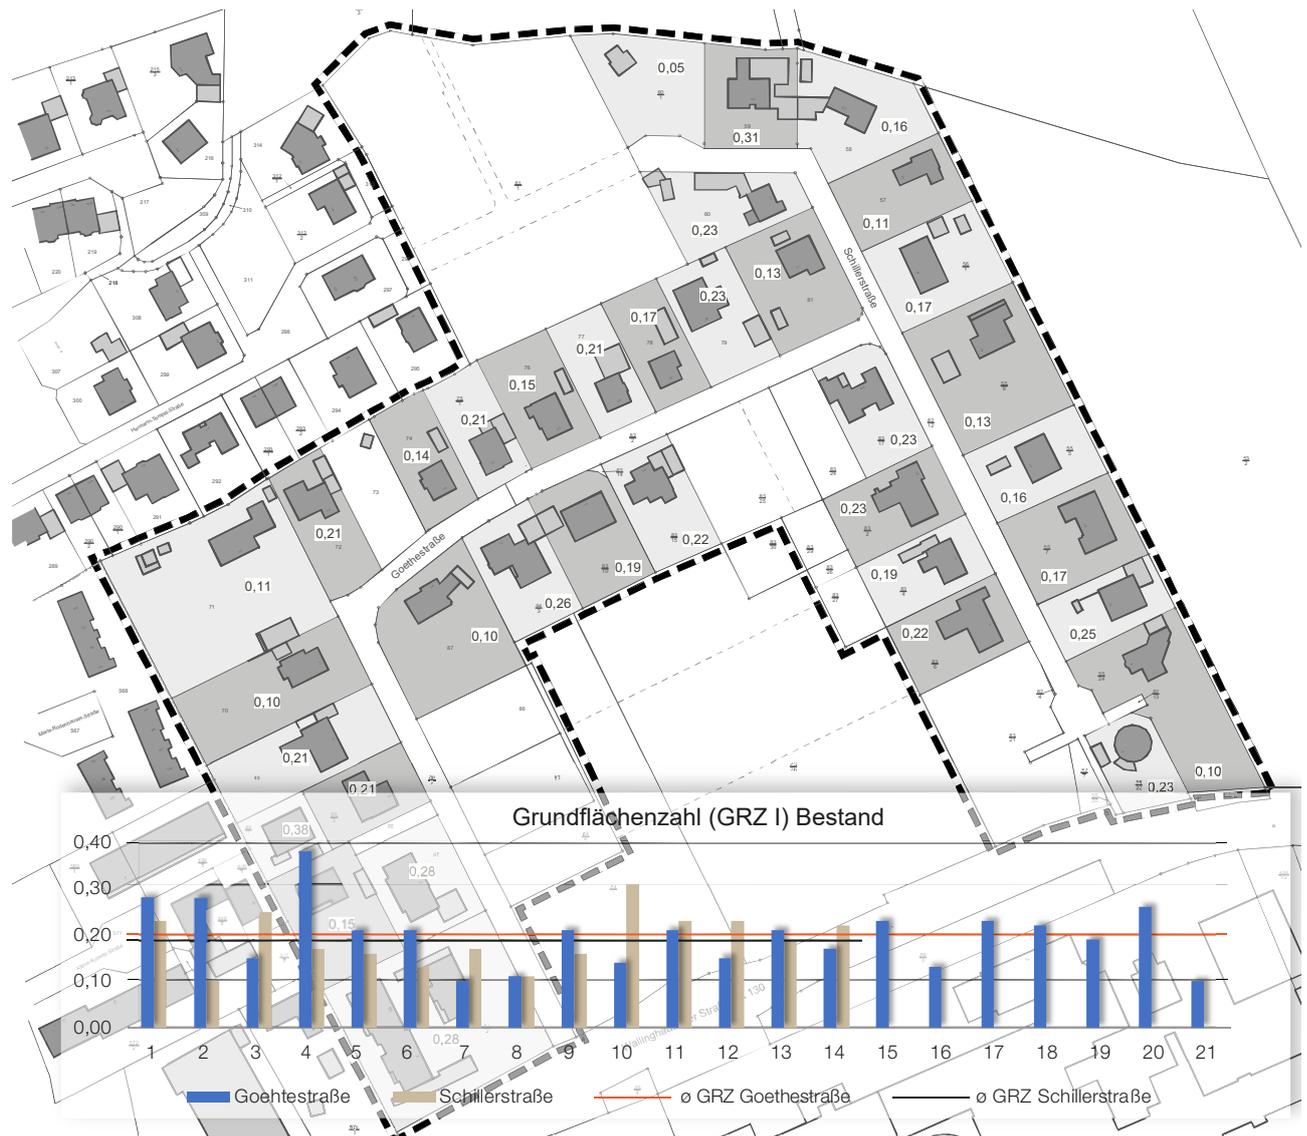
Übersichtslageplan Grundflächenzahl (GRZ I) Bestand
